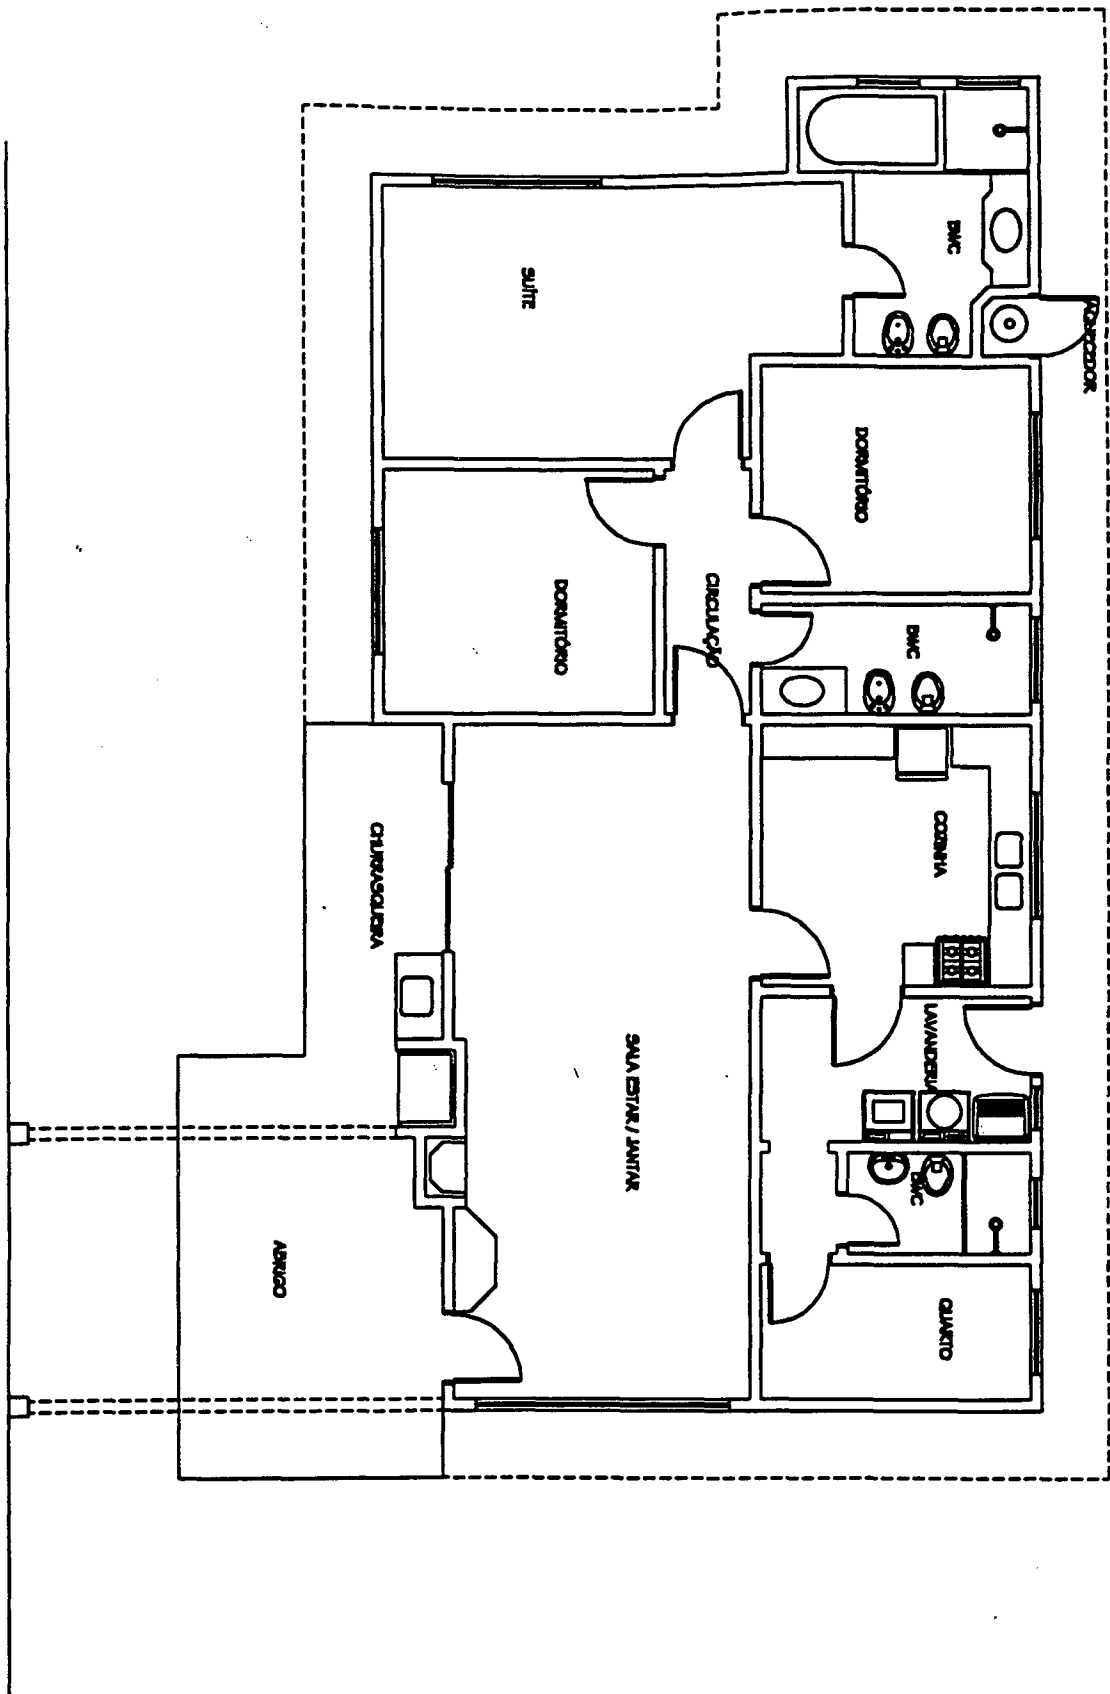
Planta baixa de um projeto arquitetônico básico para uma casa do Castel Vicenza Condominium.
